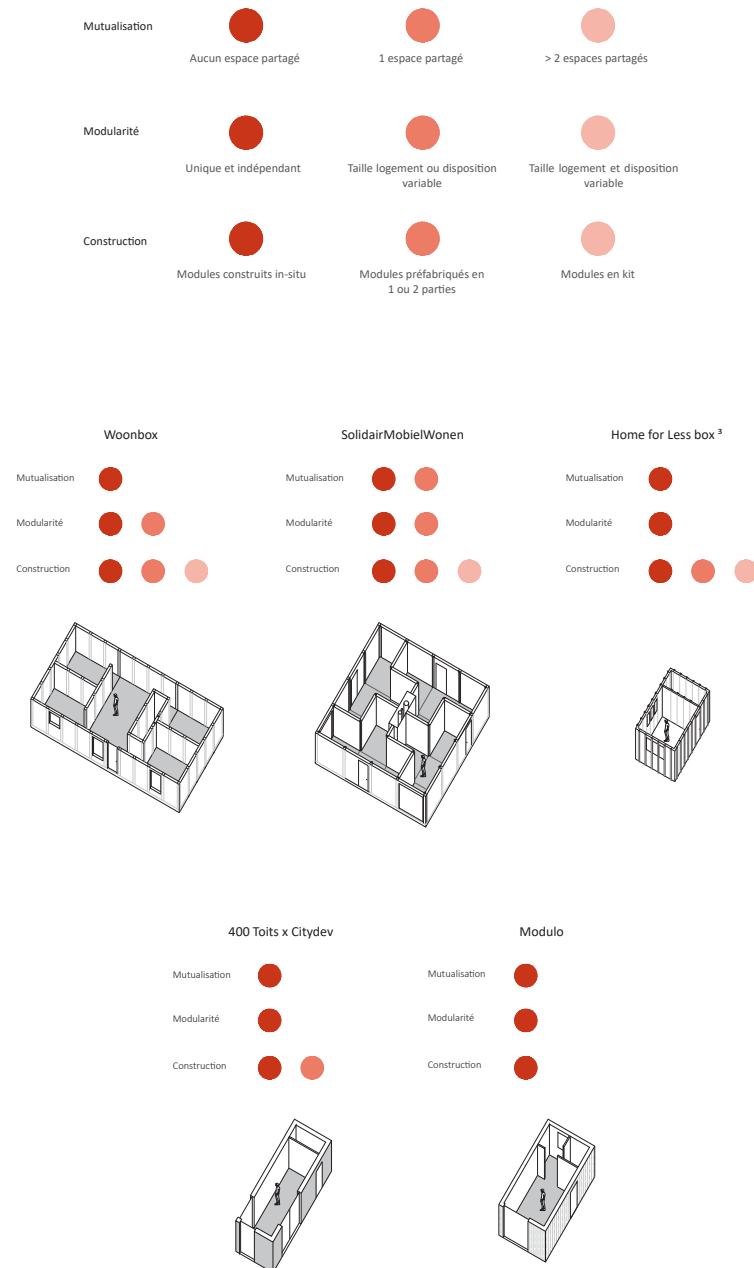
Différents modules d'hébergement temporaire sur Bruxelles
